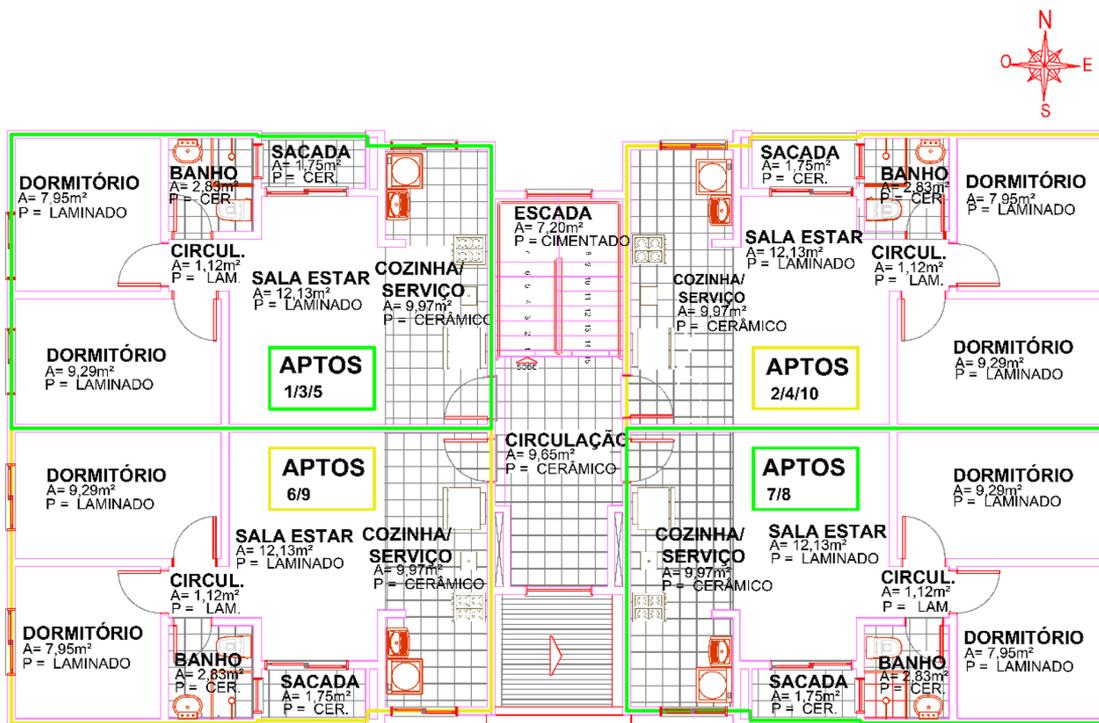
Planta pavimento tipo- alvenaria estrutural.
